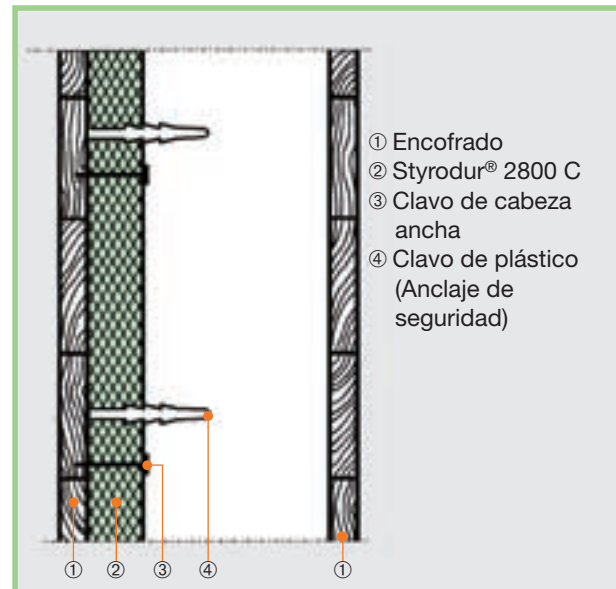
Fijación de las planchas de Styrodur® 2800 C en encofrado de madera con clavos de cabeza ancha.
